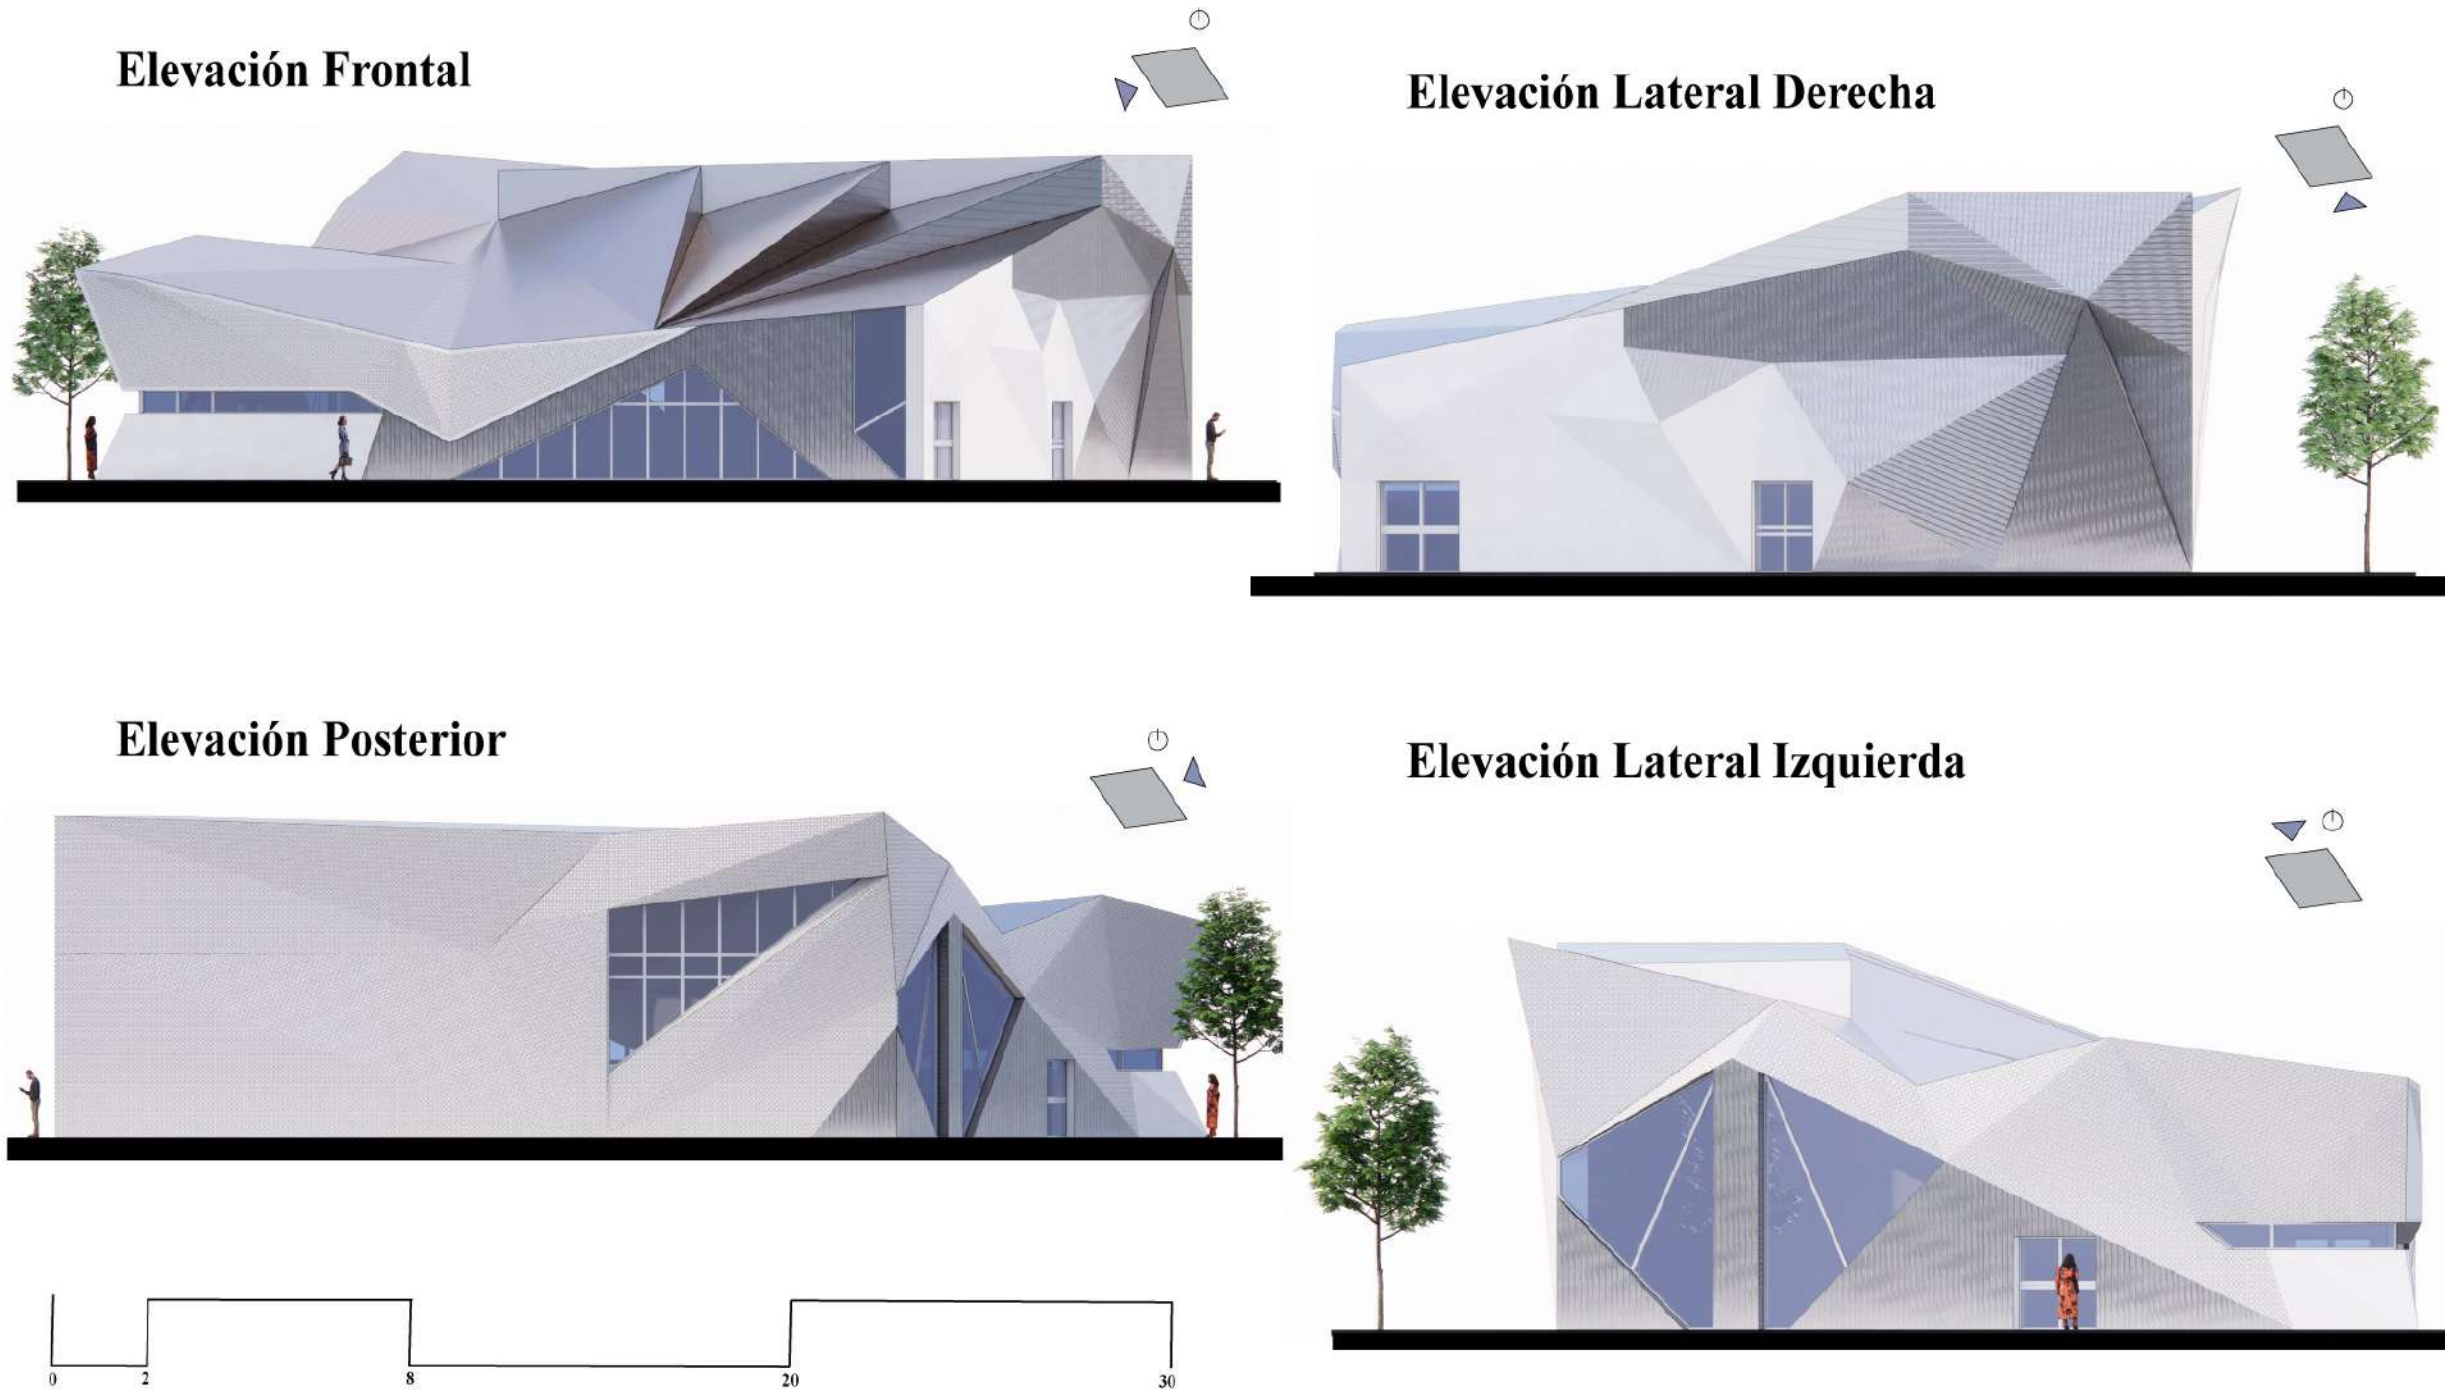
Alzados, edificio C, elaborado por autor, 2024.
